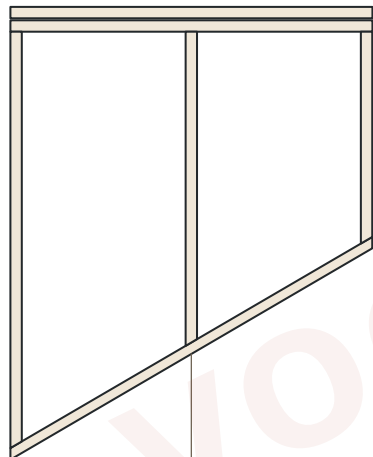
DETAIL A — stijl 38x184 C24 + beplating (schroeven h.o.h. 150)
